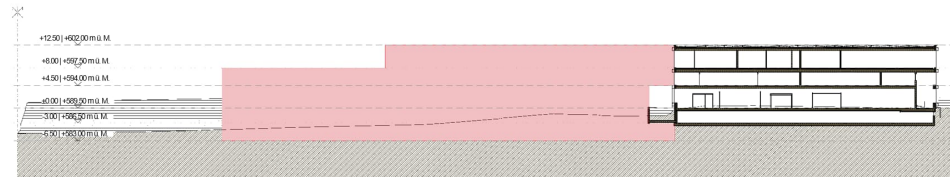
Situationsplan Erweiterung Geschäftsgebäude, Längsschnitt
